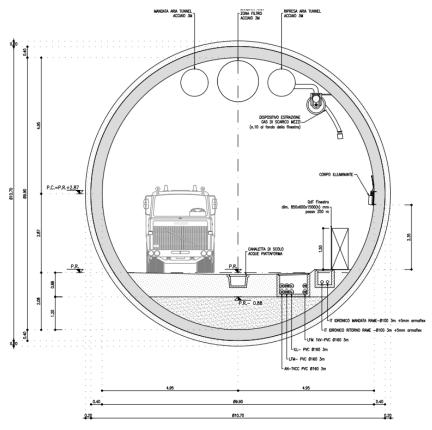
Sezione tipo galleria naturale soluzione proposta
